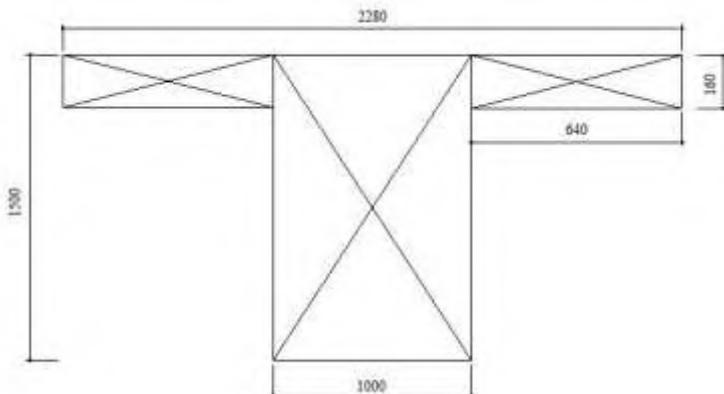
Penulangan lentur dan geser balok 100/150 As 11 B-G pada lantai 29
